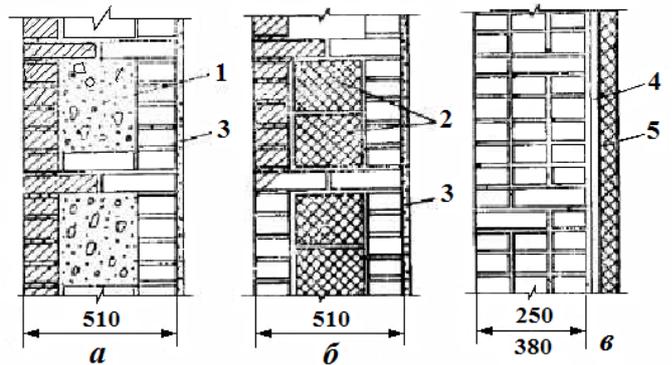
Наружные стены облегченной кладки: а – кирпично-шлаковая с кирпичными диафрагмами; б – кирпичная с термовкладышами из легкобетонных камней; в – кирпичная с утеплителем «на отnose»; 1 – шлаковая засыпка; 2 – легкобетонные термовкладыши; 3 – штукатурка; 4 – воздушная прослойка; 5 – плита утеплителя «на отnose».
